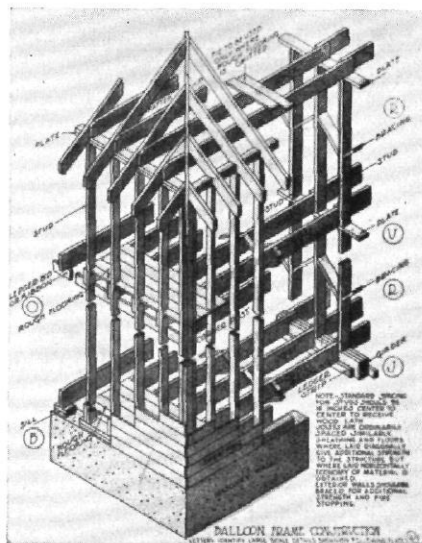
bis 12 / Die drei amerikanischen Fachwerkkonstruktionen: Balloon-Frame, Braced-Frame und Western-Frame
